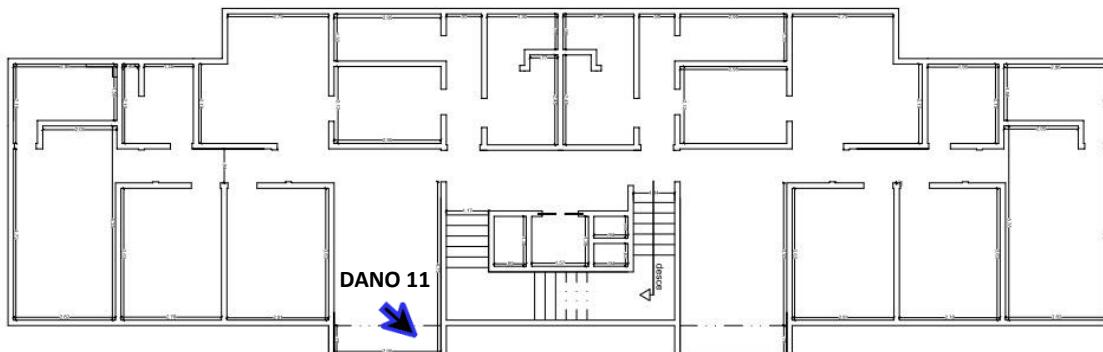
Planta Baixa (croqui) – Pavimento do 4º andar – Bloco B – Cond. Armando Lôbo.
